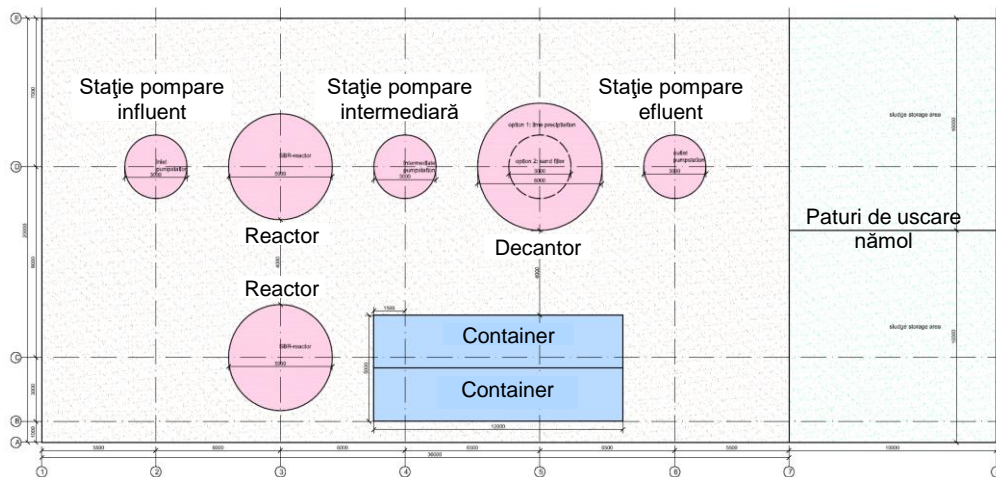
Plan de situație – Instalație de Tratare a levigatului
